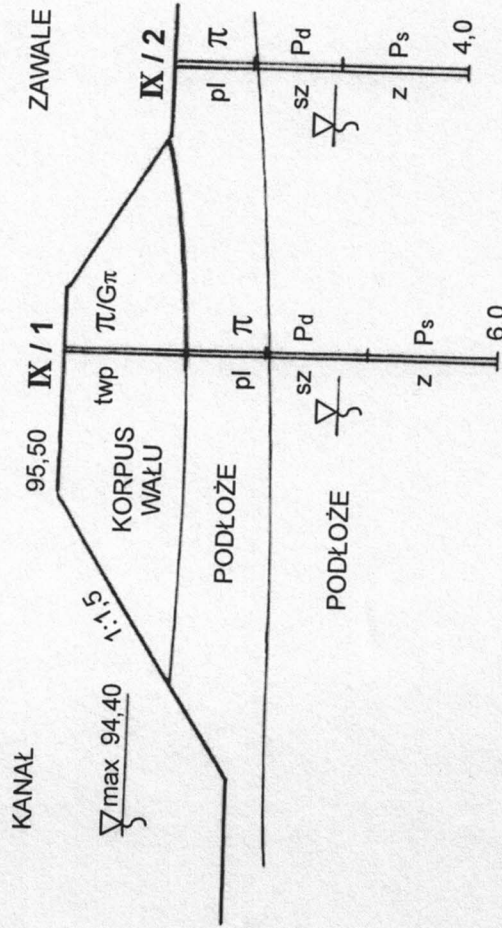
WAŁ PRAWY PRZEKROJE GEOTECHNICZNE
